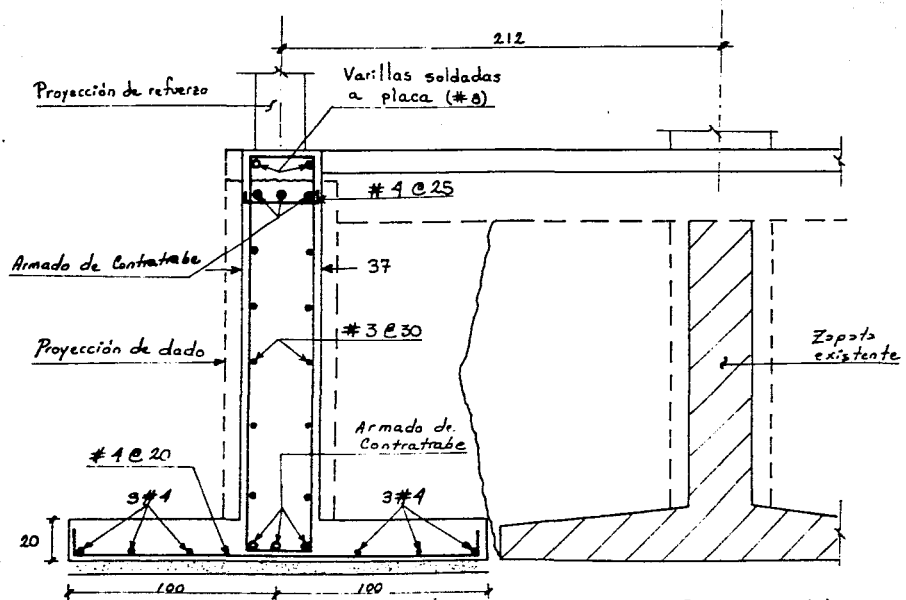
REFUERZO DE CIMENTACIÓN
